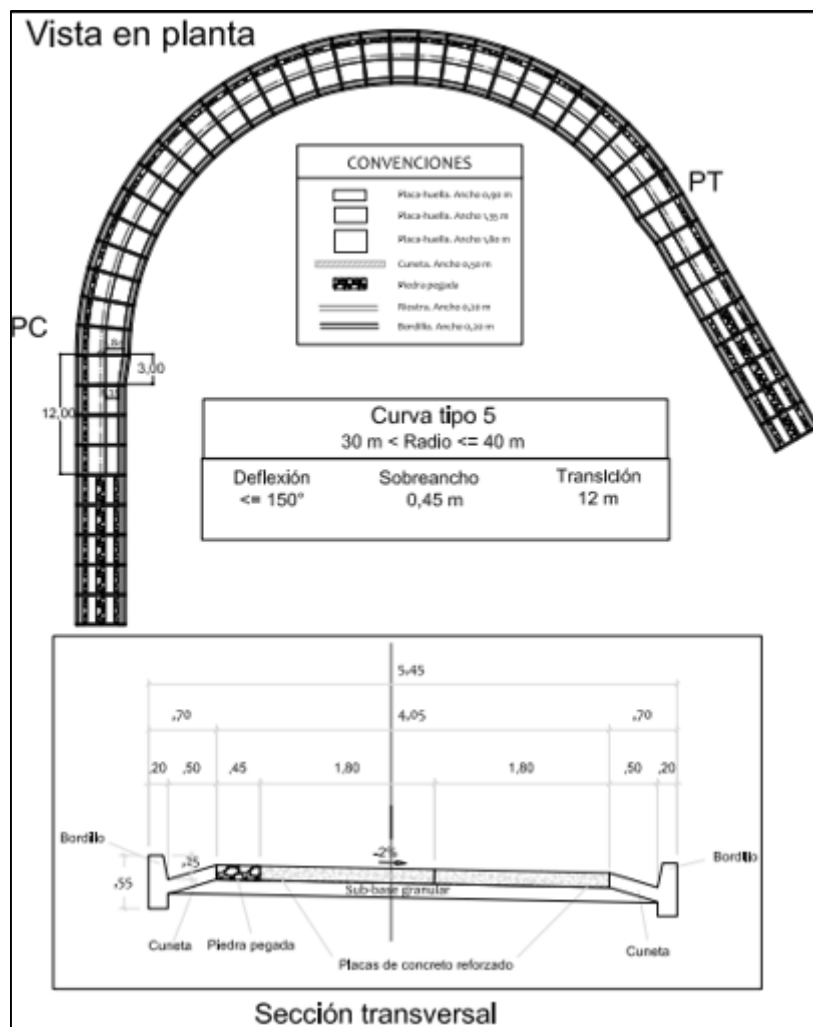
Diseño estructural con corte transversal y vista en planta para el segundo tramo curva 1.
